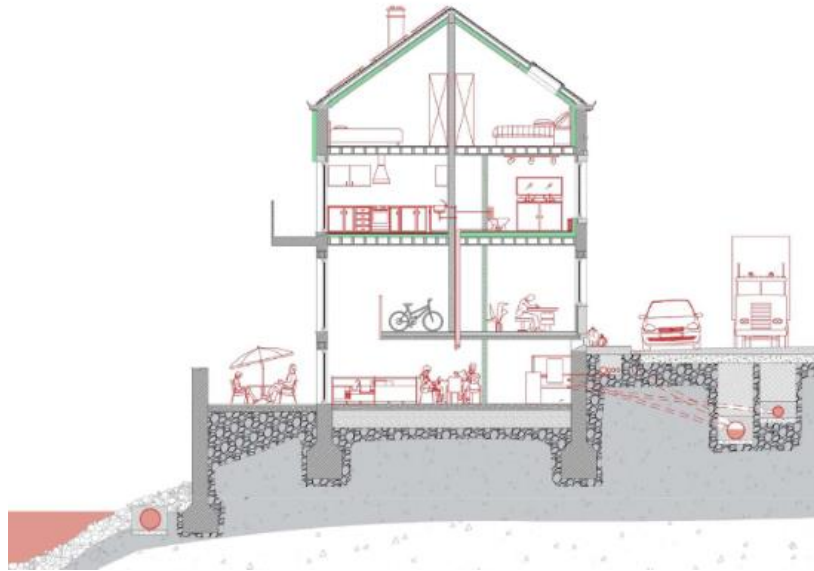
Test en plans et coupe de l'aménagement d'une maison mitoyenne avec le concept de repli et dépli – Groupe B, 2022
